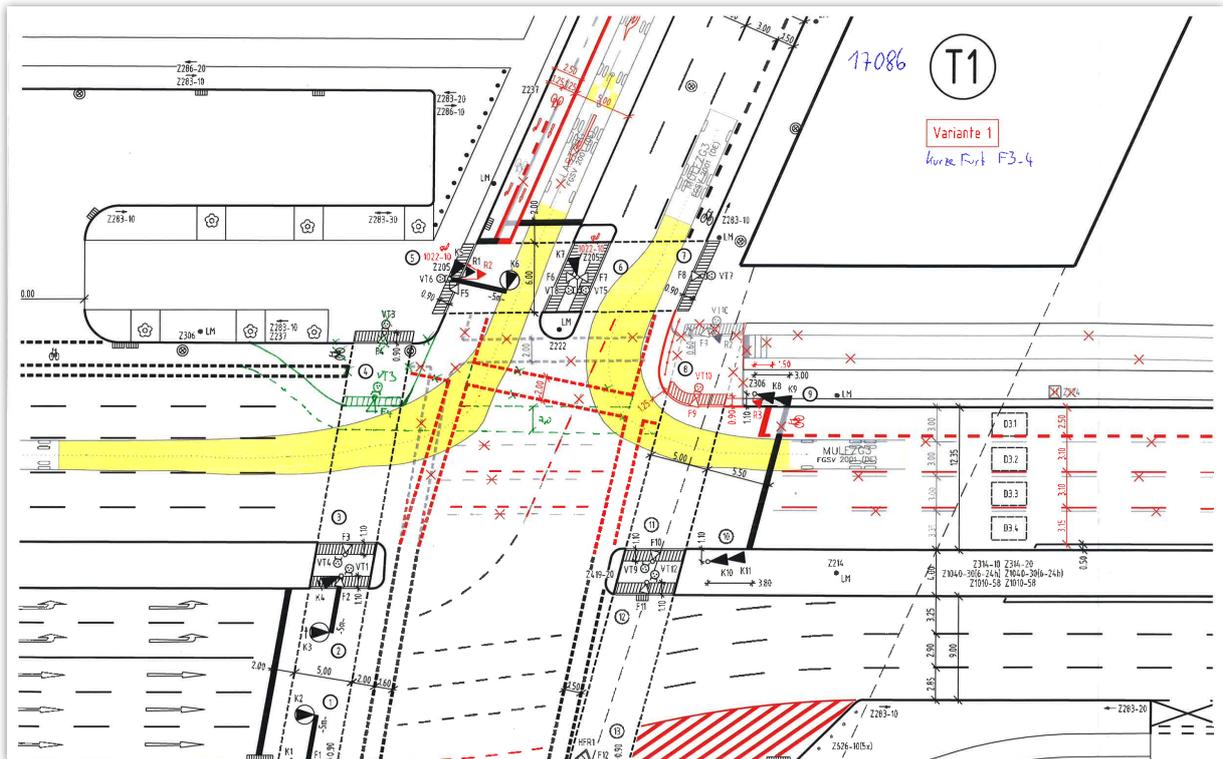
Straße des 17. Juni / Bachstraße | Lageplanentwurf Umbau Unfallkommission (VLB)
